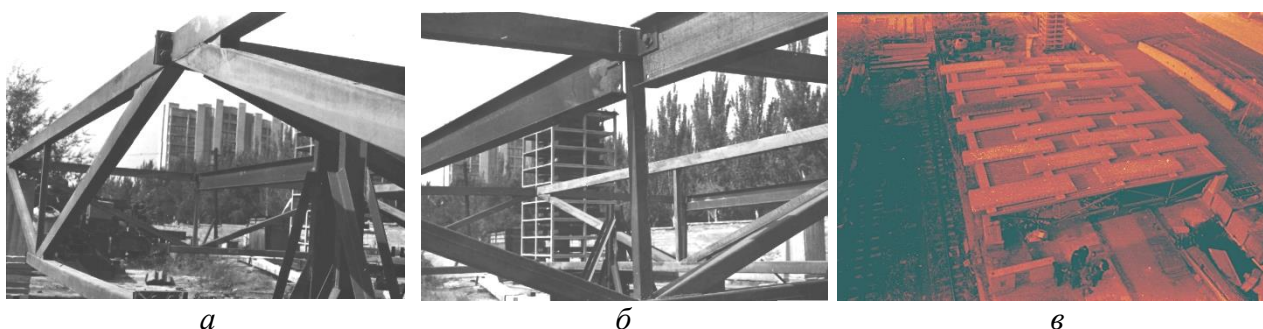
Снимки монтажа контурных (а) и внутренних (б) перекрестных стальных ферм из прямоугольных ГСП опытно-промышленного образца блока (секции) покрытия, а также его натурального испытания на статические воздействия (в), где на задних планах видна 9-этажная конструкция каркасного здания с гибким верхним этажом
